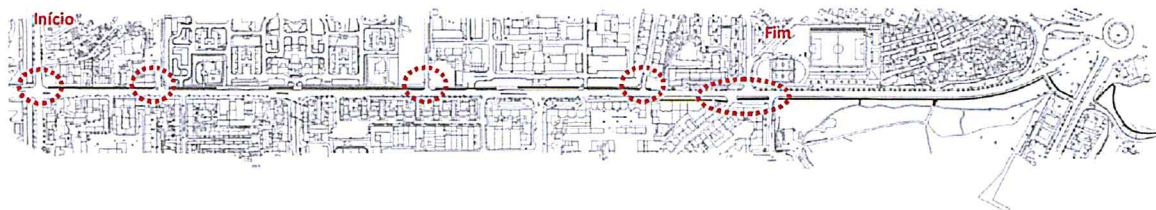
Planta geral do Troço T05 – Avenida do Brasil (Jardim do Campo Grande – Rua Alferes Malheiro).
